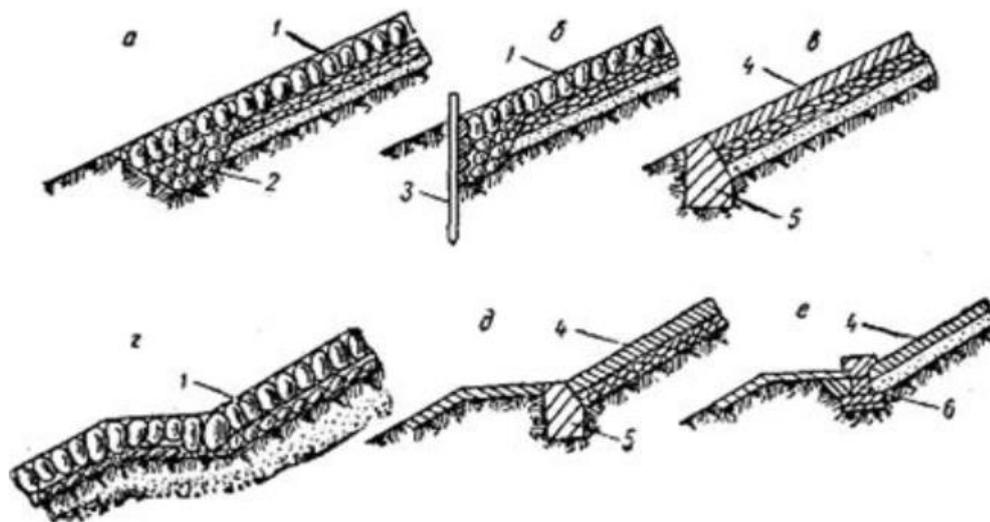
Конструкции упоров: *а, б, в* - на откосе; *г, д, е* - на бермах; 1 - мостовая; 2 - каменный упор; 3 - деревянный упор; 4 - железобетонные плиты; 5 - массивный бетонный упор; 6 - сборный железобетонный упор
